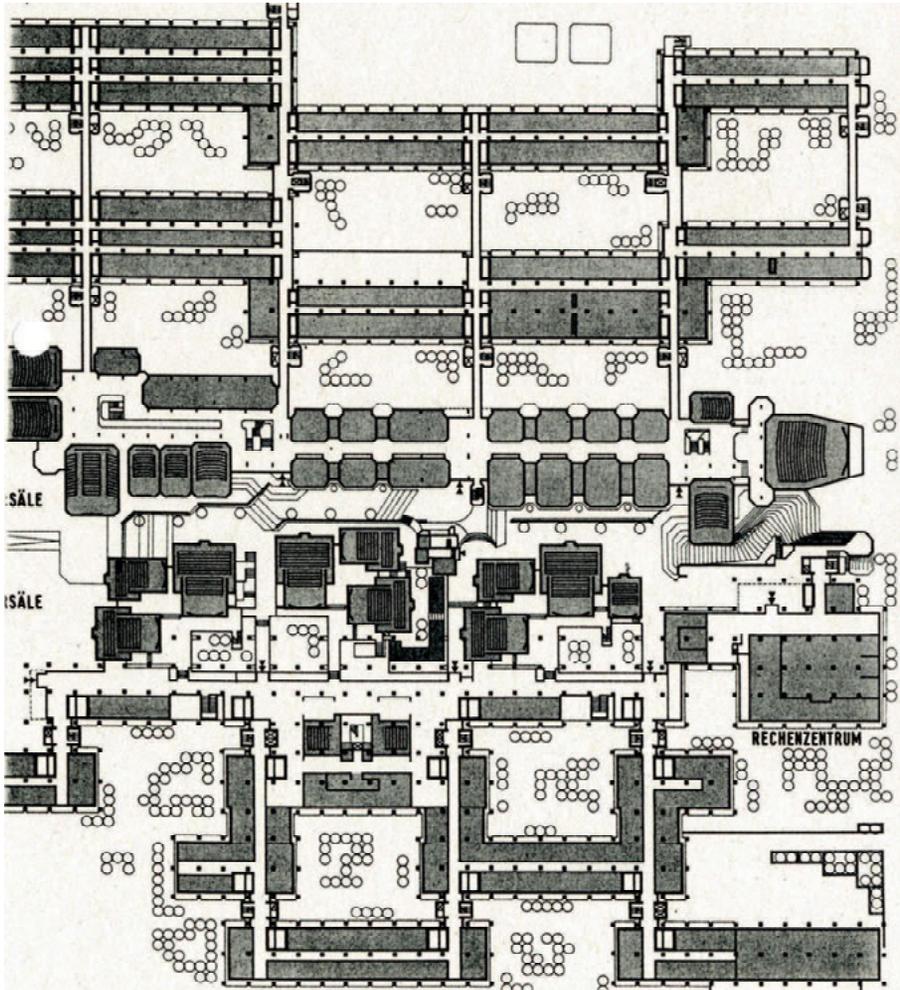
Grundriss der Gebäudegruppen 25 und 26
